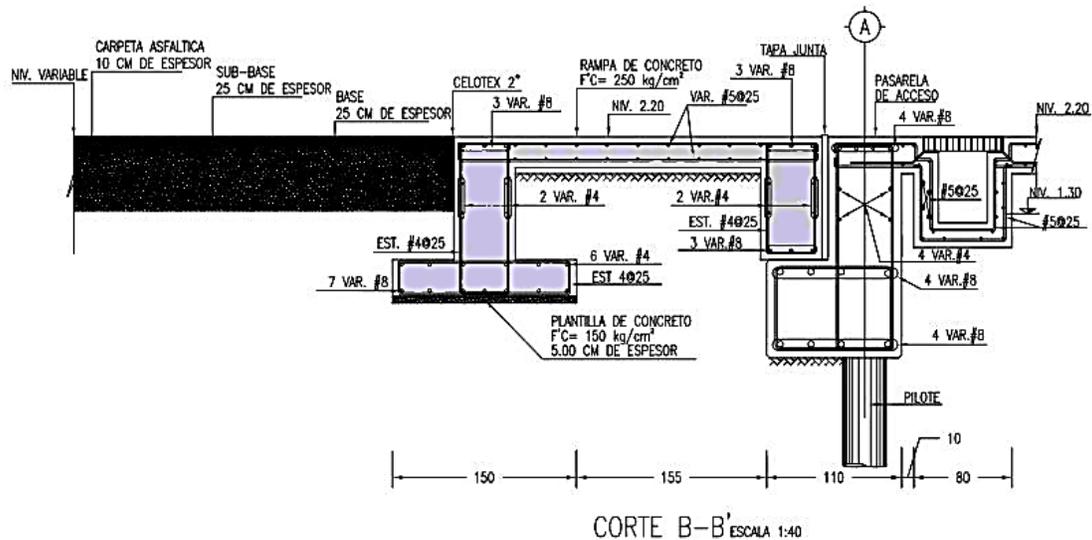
Zapata, traveses de la rampa de concreto acceso al muelle.
